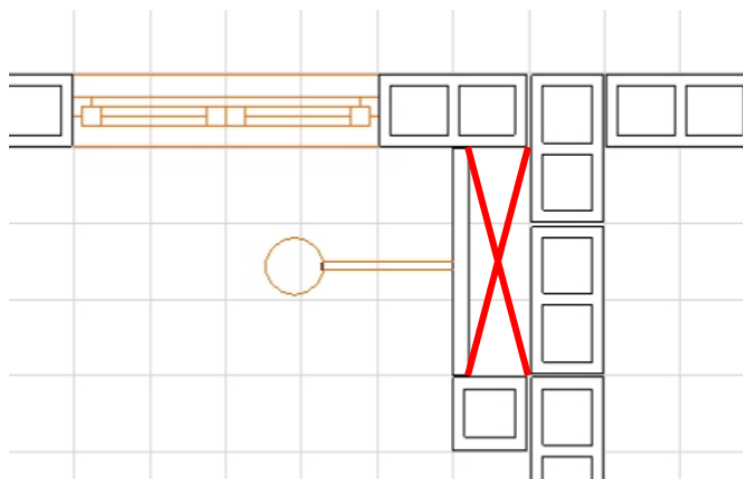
Instalação hidrossanitária com enchimento de tijolos
